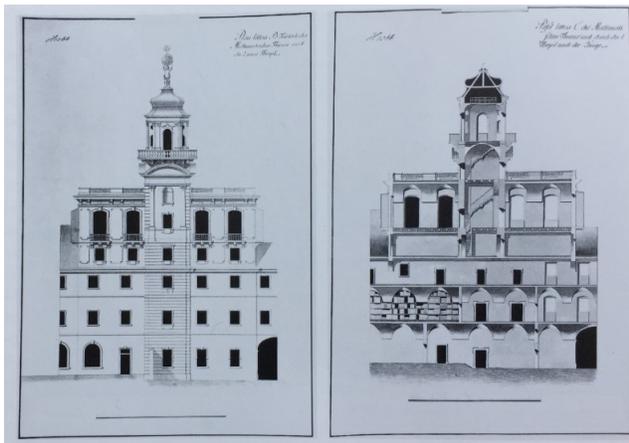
Entwurf zu Umbaumaßnahmen für die Sternwarte des Jesuitenkollegs in Prag mit Vorschlag zur Aufführung von Seitenflügeln mit Plattformen und Abänderungsvorschlag für den Beobachtungspavillon, Schnitt (links) und Aufriss (rechts), lavierte Feder um 1750/1752.
